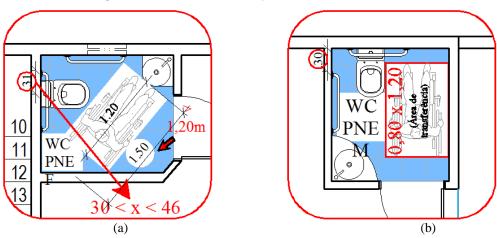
Planta Baixa de *layout* - banheiros acessíveis
